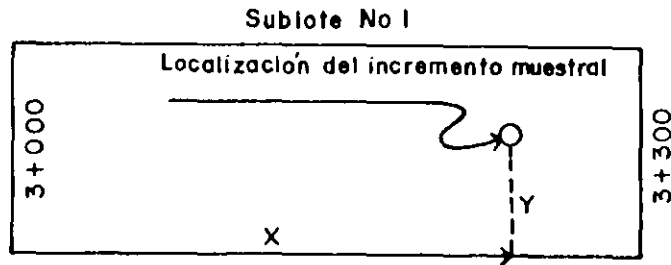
Sistema de coordenadas para un sublote de pavimento.
